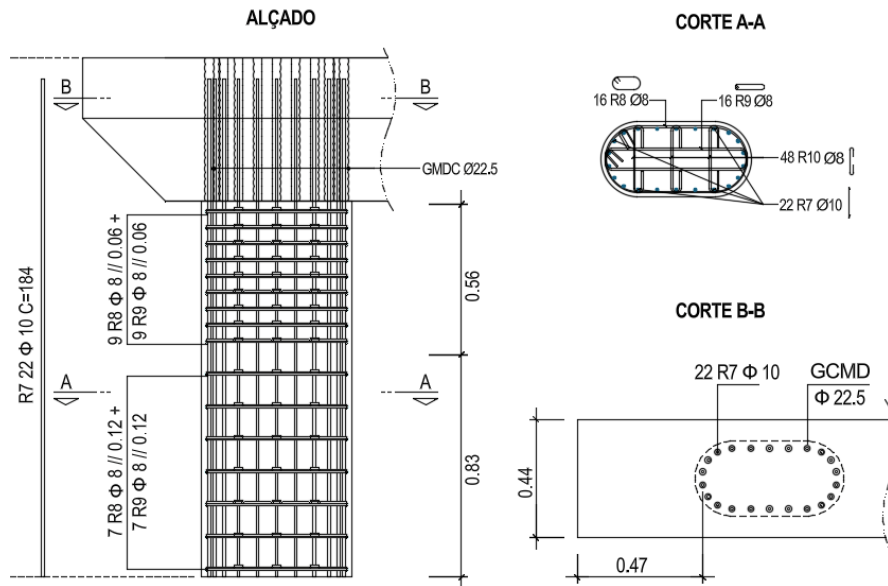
Layout de armaduras do pilar do protótipo PE0.
